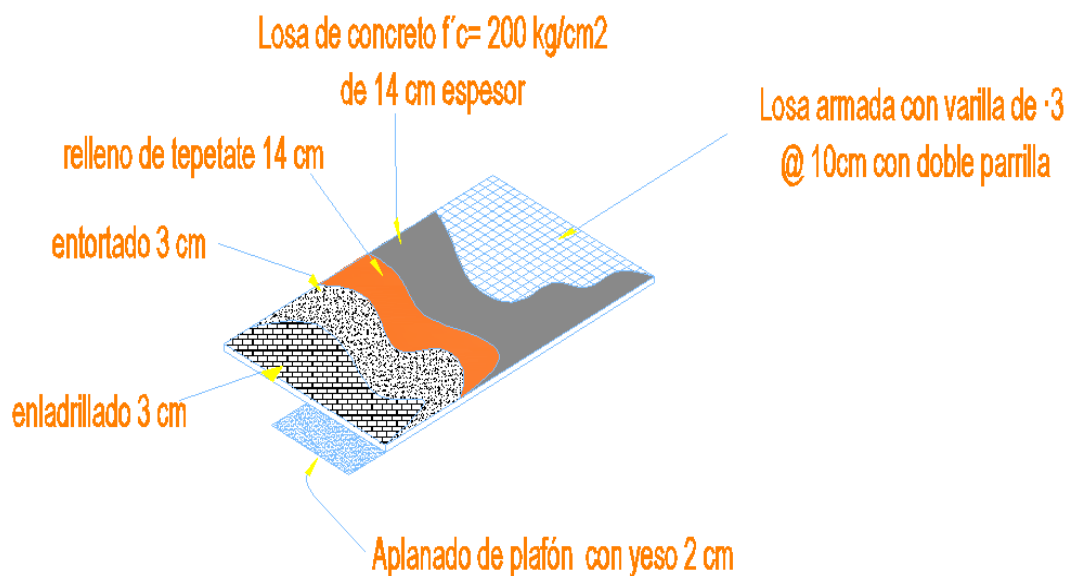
Elementos constructivos de la losa de azotea en estudio.
